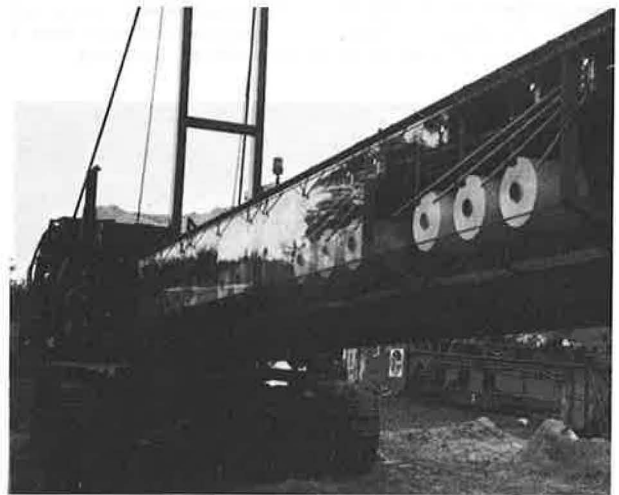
Vue des bobines de fil sur la flèche de la machine
